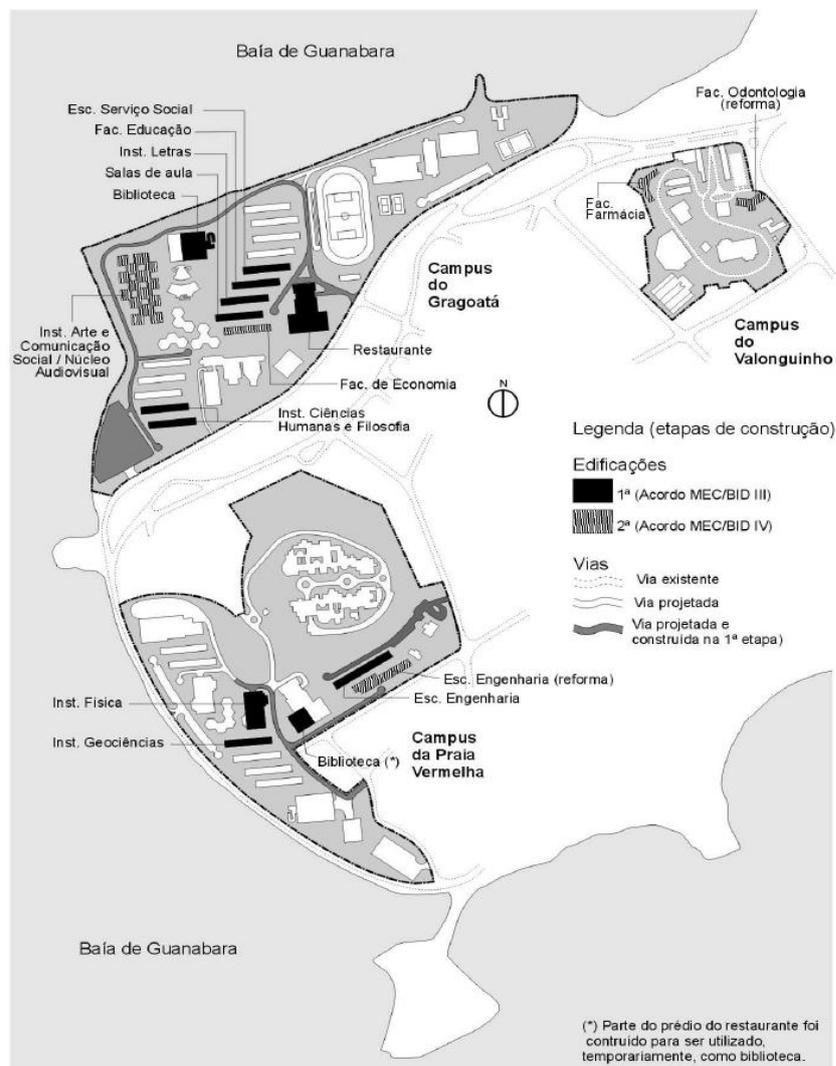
Planta de situação do campus da UFF: etapas de construção
